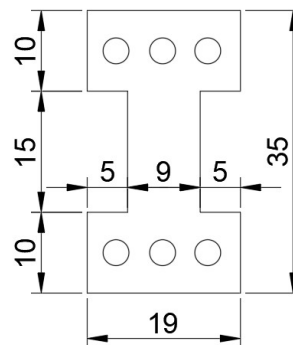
detalhe da seção transversal dos pilares dos hangares.
